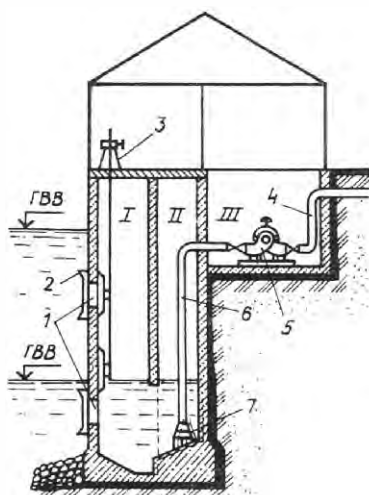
Схема берегового водозабора с водоприемной камерой:
